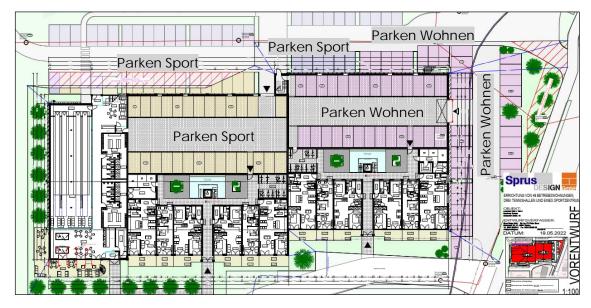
Planzeichnung des Erdgeschosses der geplanten Anlage mit Eintragung der jeweiligen Parkplatzzuordnungen /38/
